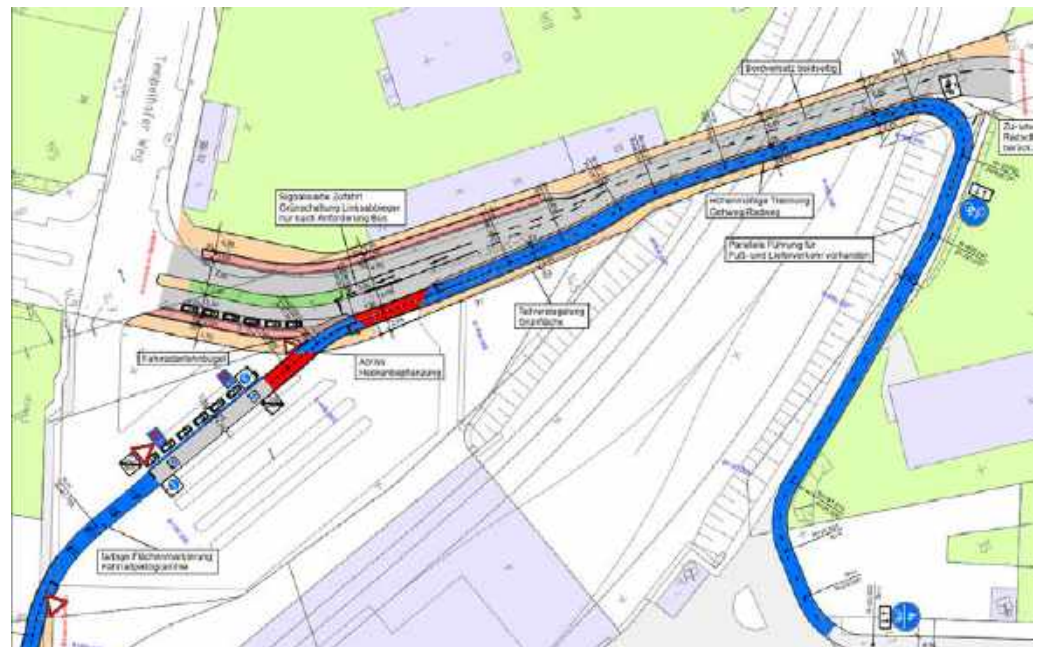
Vorzugsführung Wilhelm-Kabus-Straße (Lageplan)
